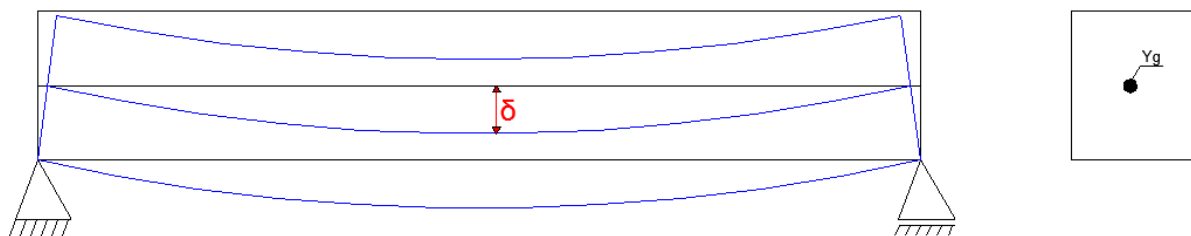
Deformada de uma viga simplesmente apoiada sujeita a uma acção uniforme.
